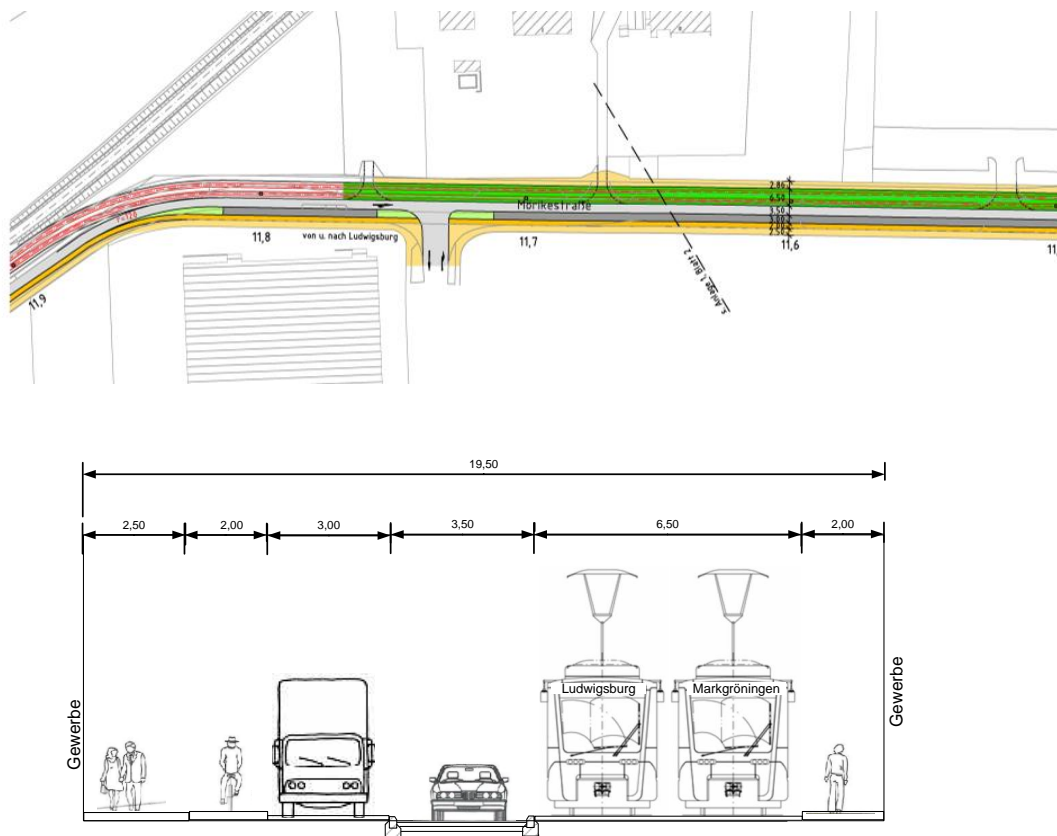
Lageplan und Querprofil Mörikestraße Teil West, Blickrichtung Westen (Planung)
